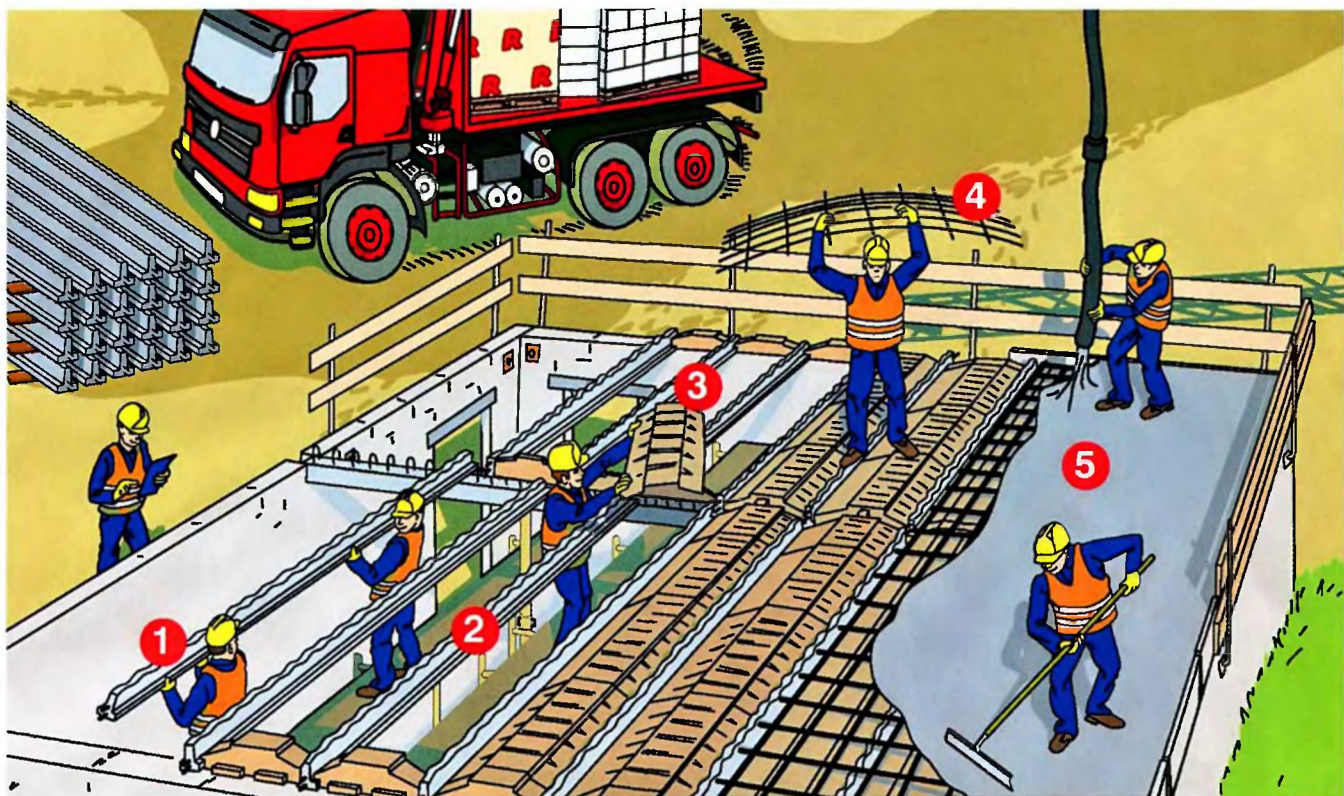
Этапы монтажа перекрытия: 1 — монтаж балок; 2 — установка временных монтажных опор (при пролёте более 5,5 м); 3 — укладка элементов заполнения (несъёмной опалубки); 4 — укладка арматурной сетки; 5 — бетонирование перекрытия.
